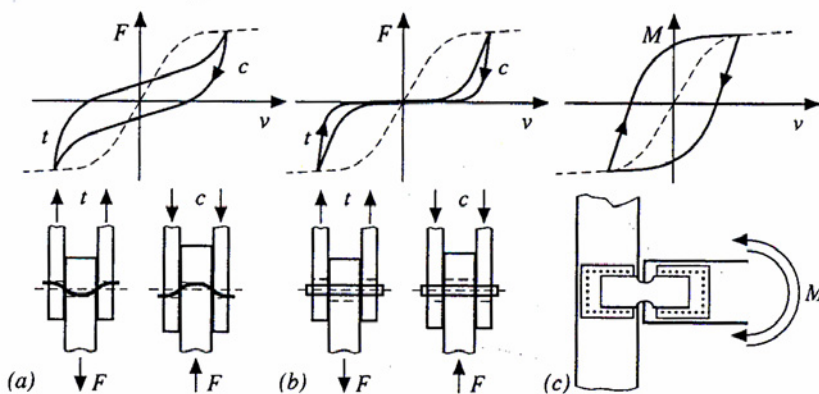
Verbindungen unter zyklischer Last: a) dünner Stabdübel, b) gedrungener Stabdübel, c) Stahlblech - Holz [1]
